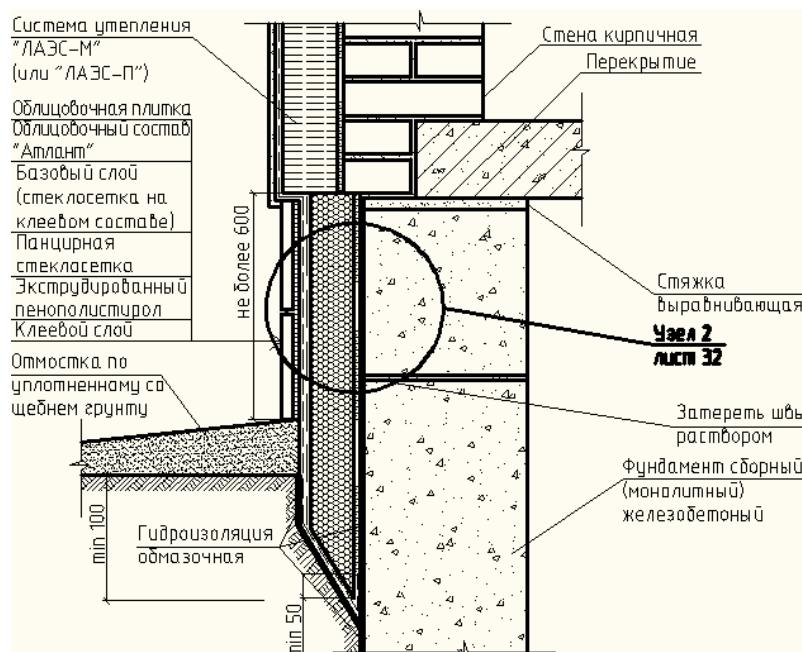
Облицовка утепленного цоколя из монолитного (сборного) железобетона плиткой на облицовочном составе "Атлант"
